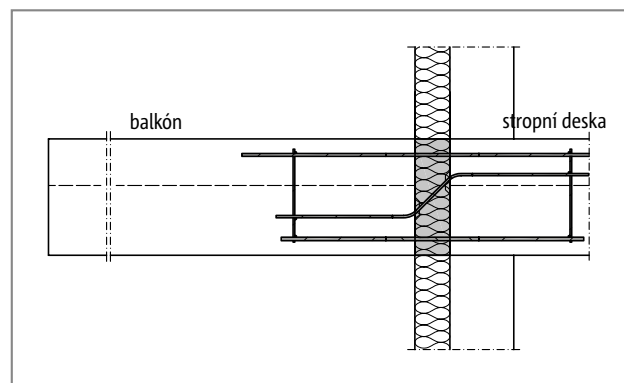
Schöck Isokorb® typ SXT: Balkónová konstrukce s volně vyloženými průvlaky
